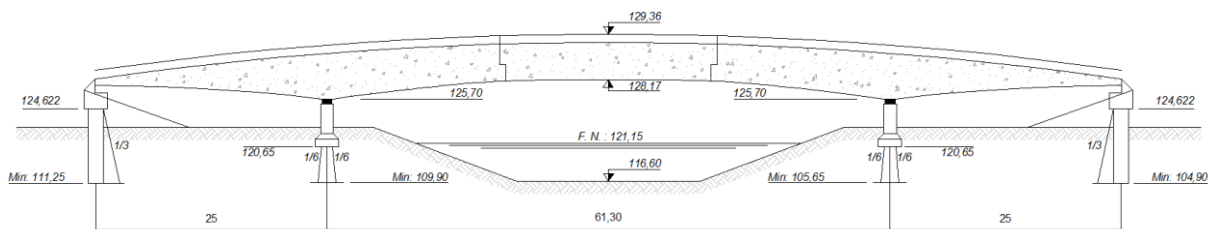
PLAN DU PONT N°1 À SENEFFE
